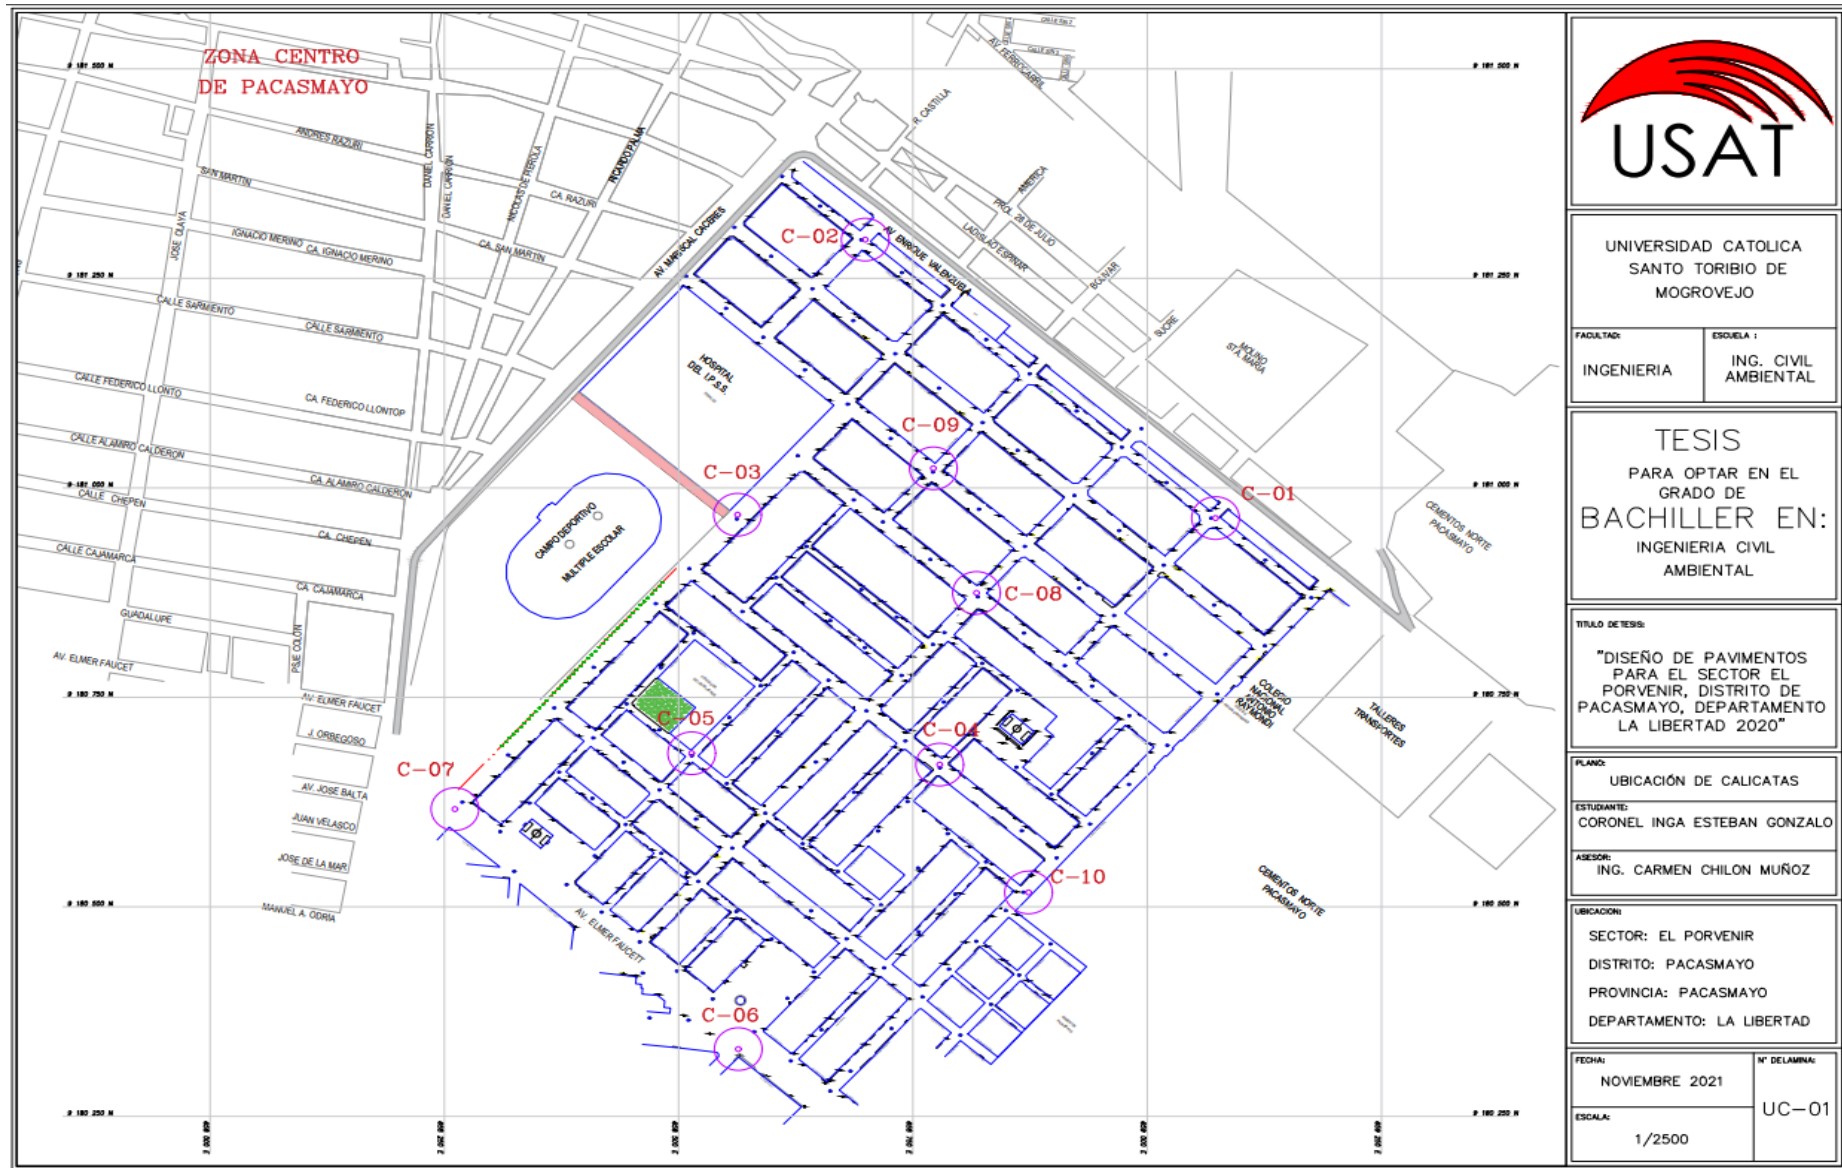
PLANO DE UBICACIÓN DE CALICATAS– FUENTE: ELABORACIÓN PROPIA
